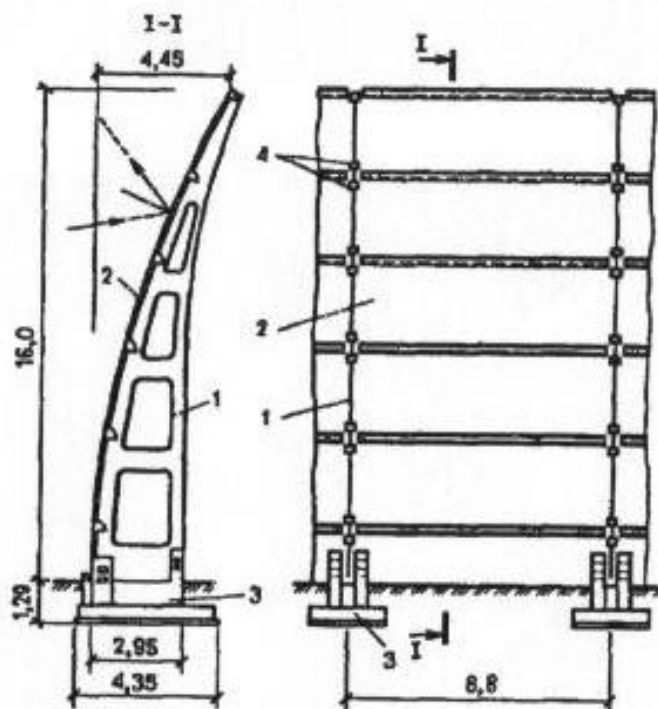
Конструкция шумозащитного экрана из железобетонных элементов заводского изготовления: 1 – решетчатая стойка; 2 – панель; 3 – фундамент; 4 – болт
